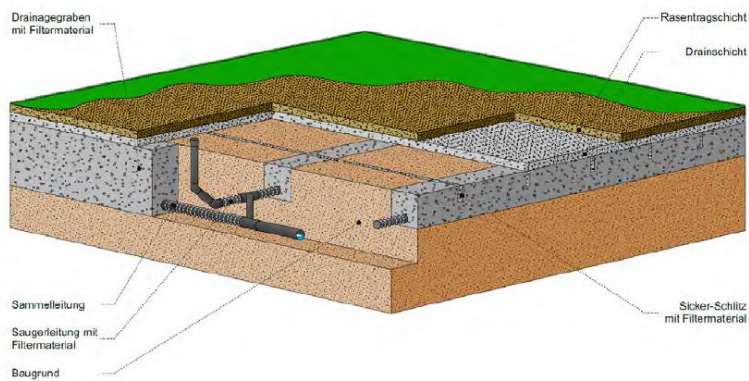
Drainschichtbauweise (Belastbar 30h/Woche (900 h im Jahr)
